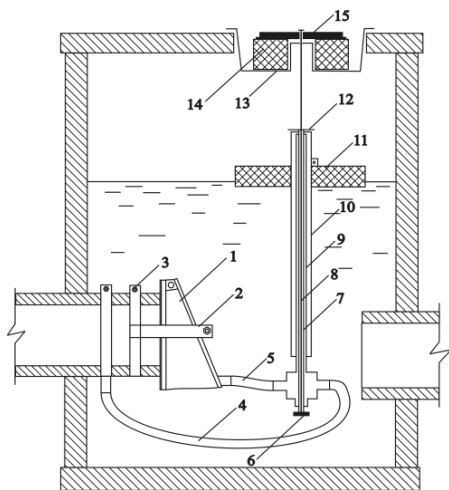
Гидравлический регулятор водоподачи: 1 – запорный орган; 2, 3 – кронштейны крепления запорного органа; 4 – шланг для соединения рабочей камеры запорного органа с верхним бьефом; 5 – соединительный шланг; 6 – регулировочный клапан; 7 – труба; 8 – тяга регулирующего клапана; 9 – стойка; 10 – труба крепления поплавка; 11 – поплавок; 12 – упор; 13 – осадкомер; 14 – поплавок осадкомера; 15 – груз для регулировки веса поплавка осадкомера
